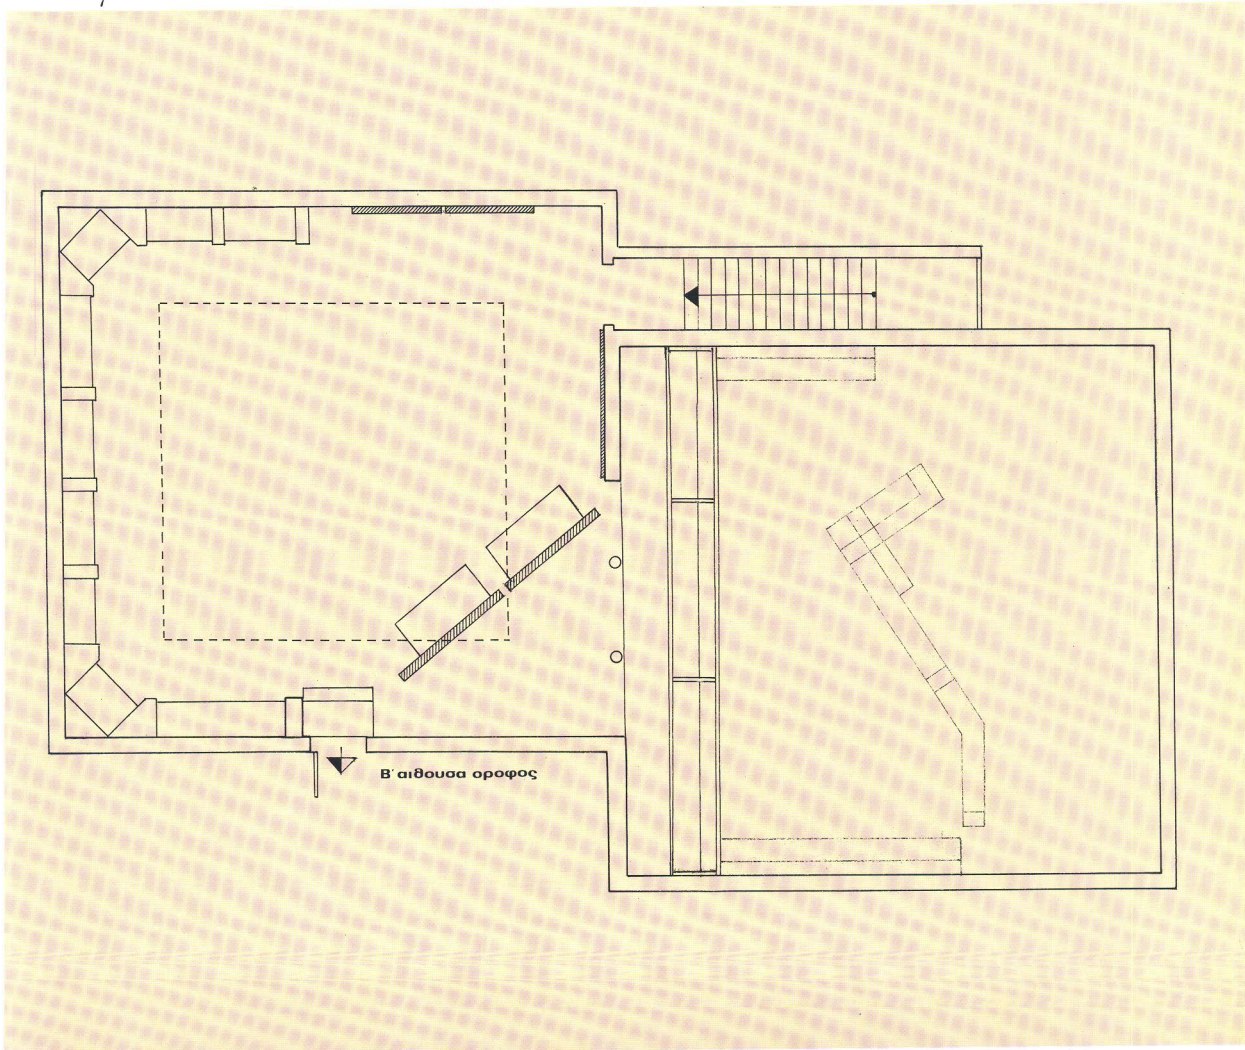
Plan du rez-de-chaussée de l'exposition.
